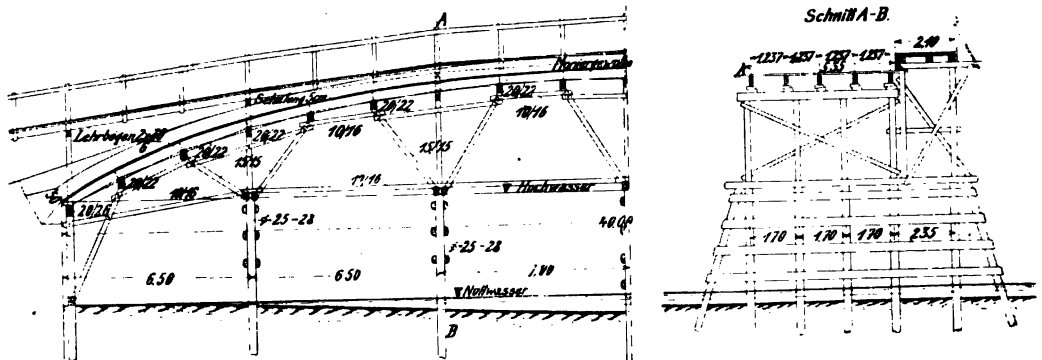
Eingerüstung der Ybbsbrücke bei Groß-Hollenstein.
